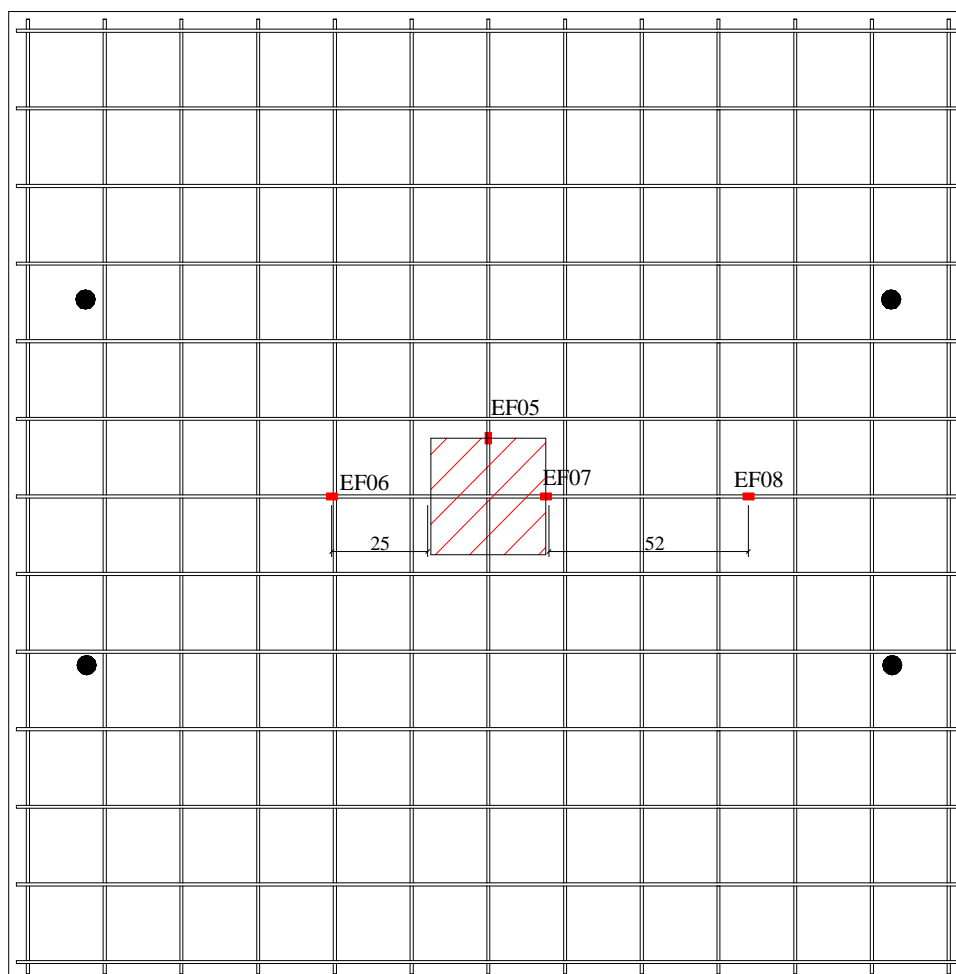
Extensometria da armadura de flexão inferior
